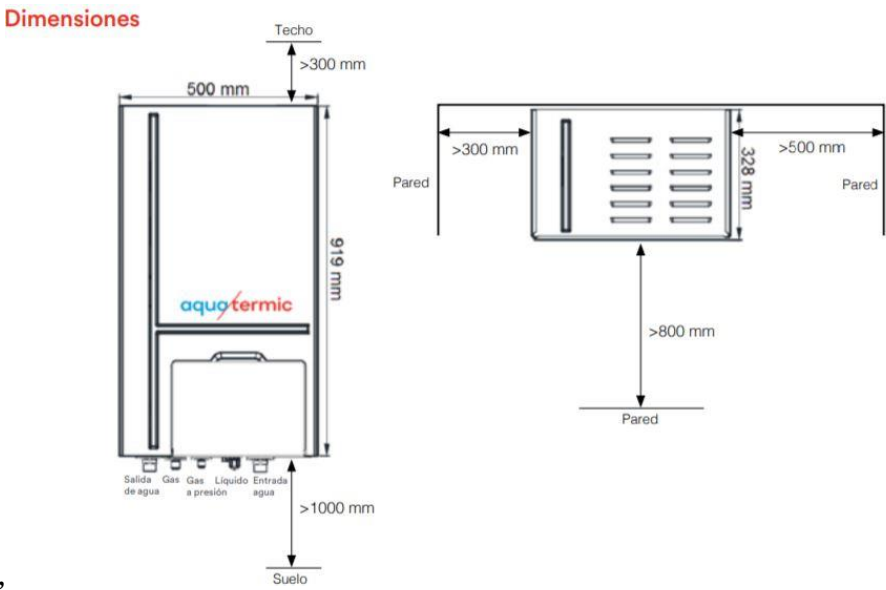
Posición y dimensiones del módulo hidráulico.
